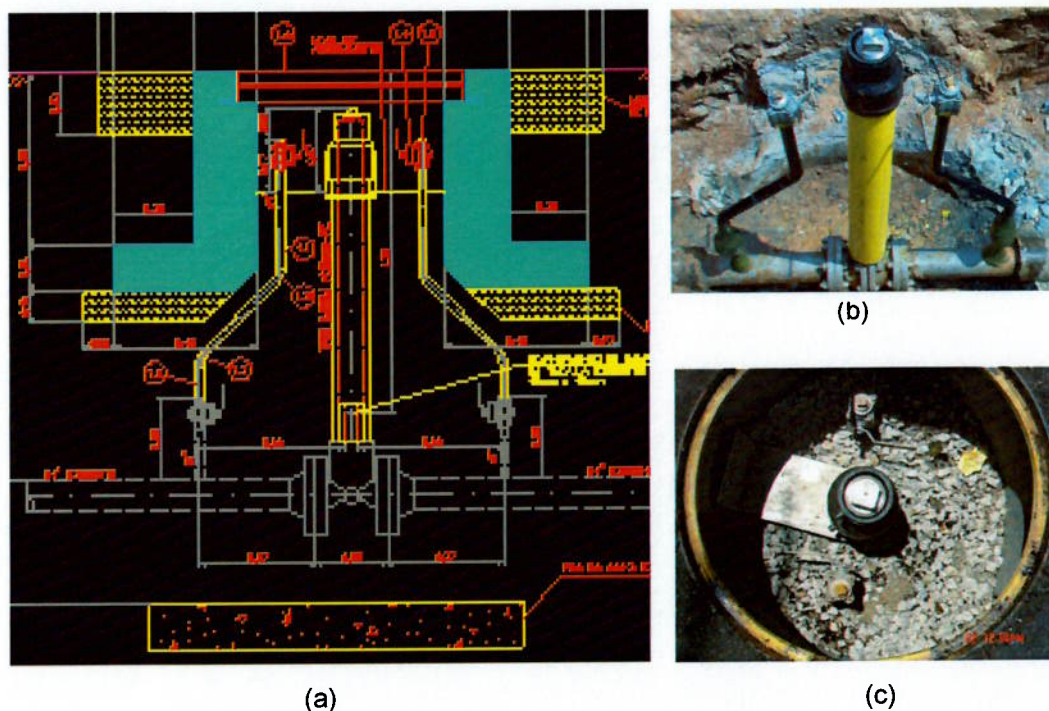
(a) Desenho do projeto executivo; (b) foto tirada durante a execução da obra e (c) obra finalizada.
